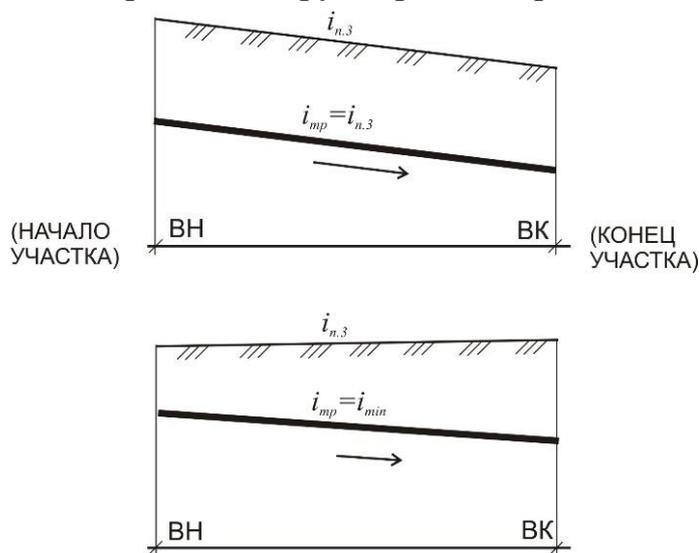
Схемы выбора уклона прокладки трубопровода
